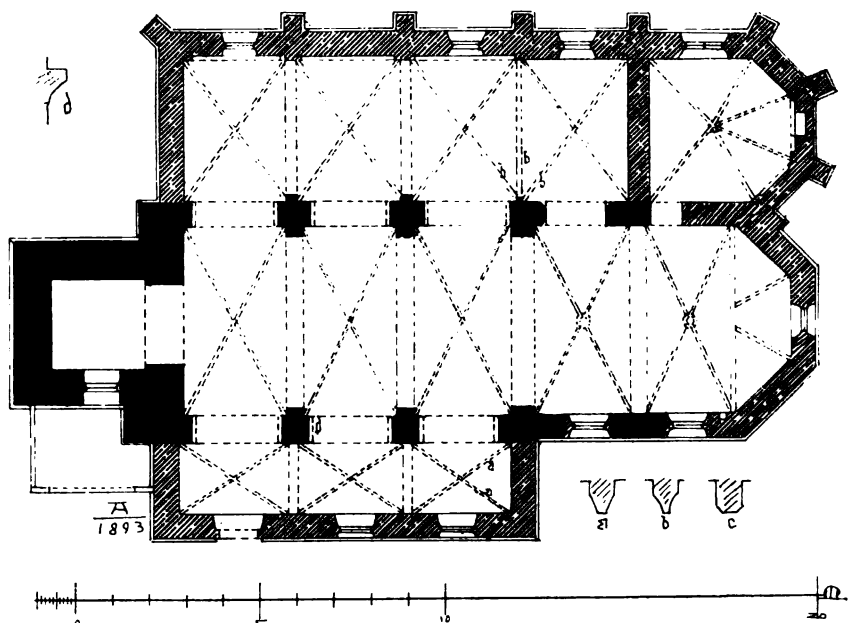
Thorr. Grundriss der alten katholischen Pfarrkirche.
